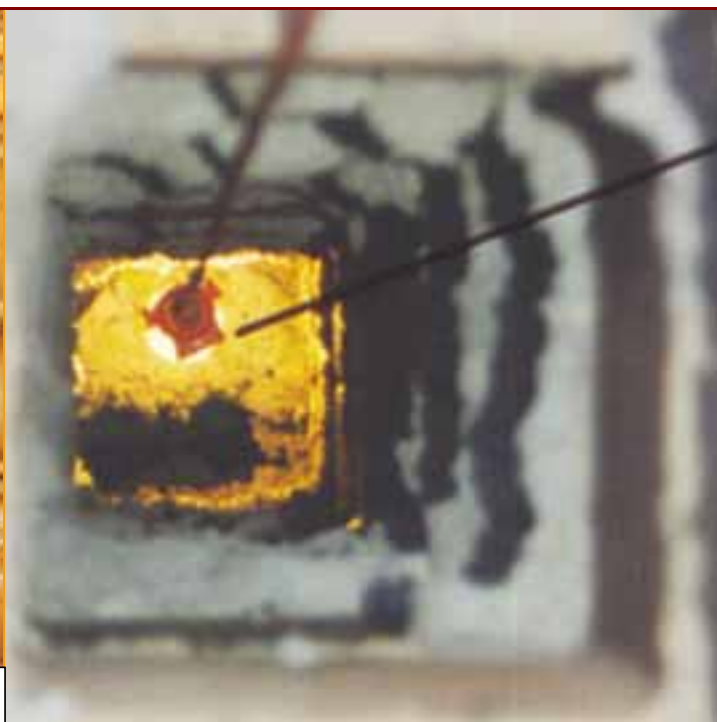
Chimenea correspondiente a un edificio de 3 plantas. Material adecuado ISH, ejecución muy defectuosa, con abundantes restos de masa, la sección ha sido obstruida, casi en su totalidad, en el paso por el forjado.
